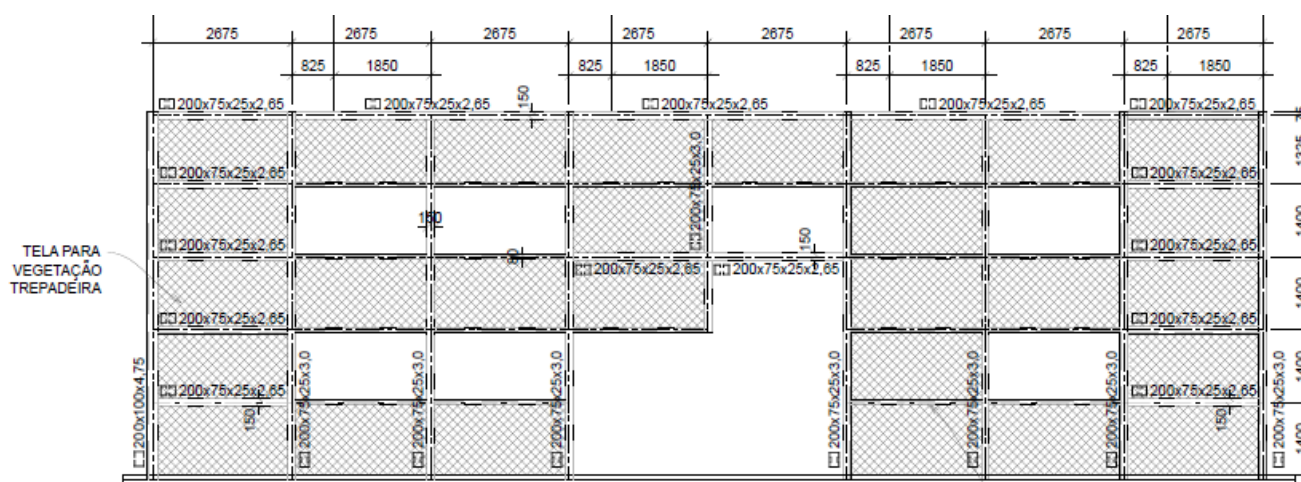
Elevação de uma das laterais da fachada – Galpão UDR
